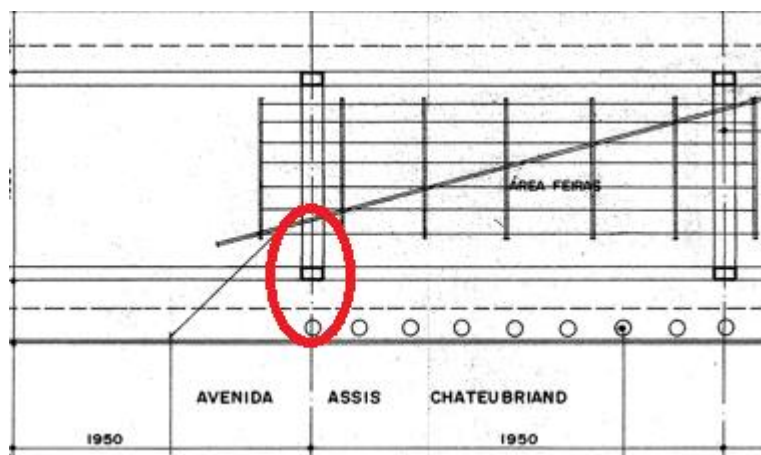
Planta de situação da patologia da Figura 5, acesso em planta arquitetônica do viaduto Santa Tereza cedida pela Prefeitura de Belo Horizonte.
